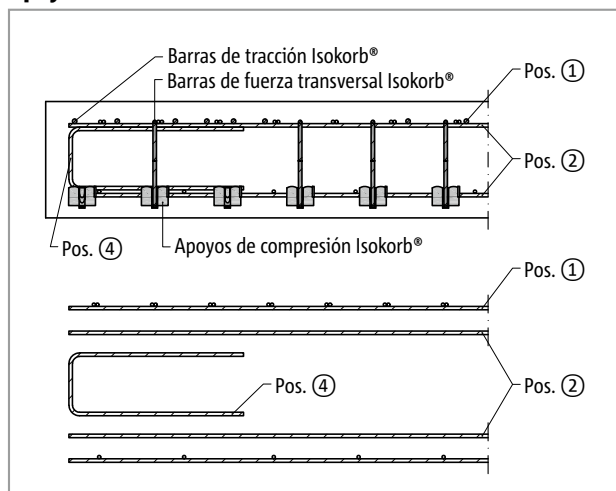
Schöck Isokorb® T tipo K-M1 hasta M11: Armadura in situ del lado del balcón en la sección A-A; pos.4 = refuerzo constructivo en el borde libre perpendicular al Schöck Isokorb®
